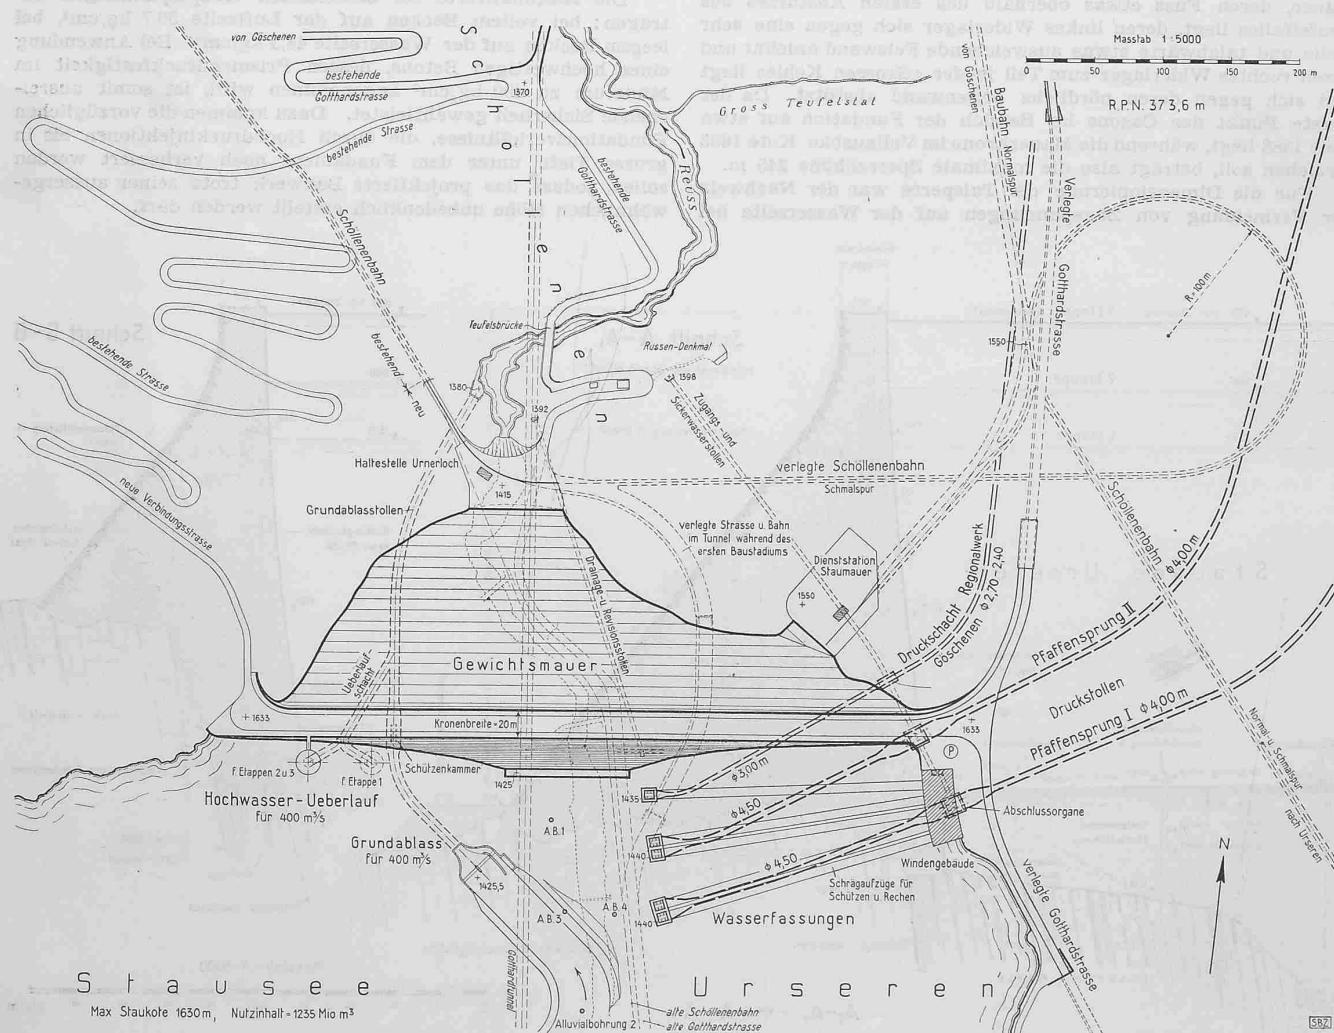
Staumauer Schöllenen, Lageplan 1:5000
